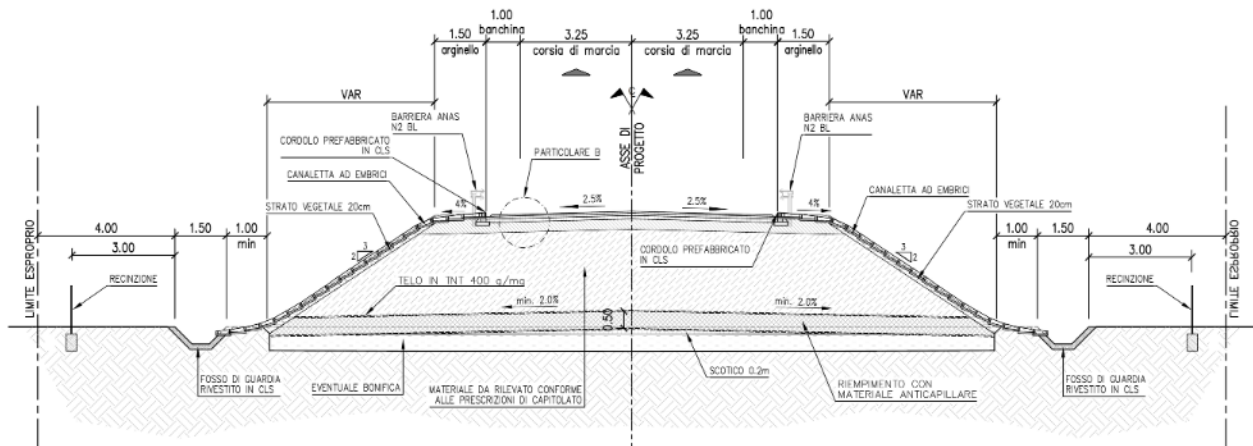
Sezione tipo in rilevato dell'asse secondario – Strada di Accesso alla Dorsale Consortile CASIC
